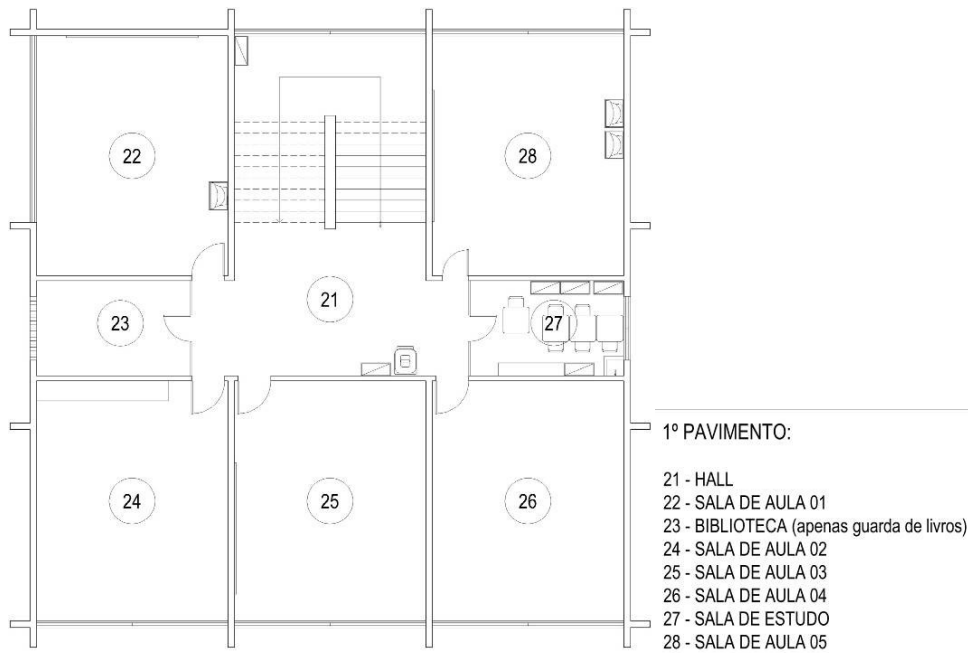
Planta baixa e legenda do 1º pavimento da Escola Albert Schweitzer.
